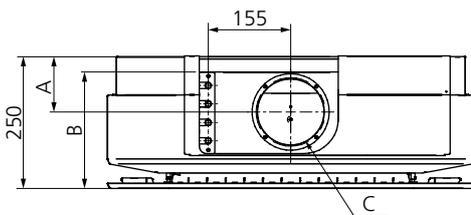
ADAPT Parasol EX 690, Seitenansicht
